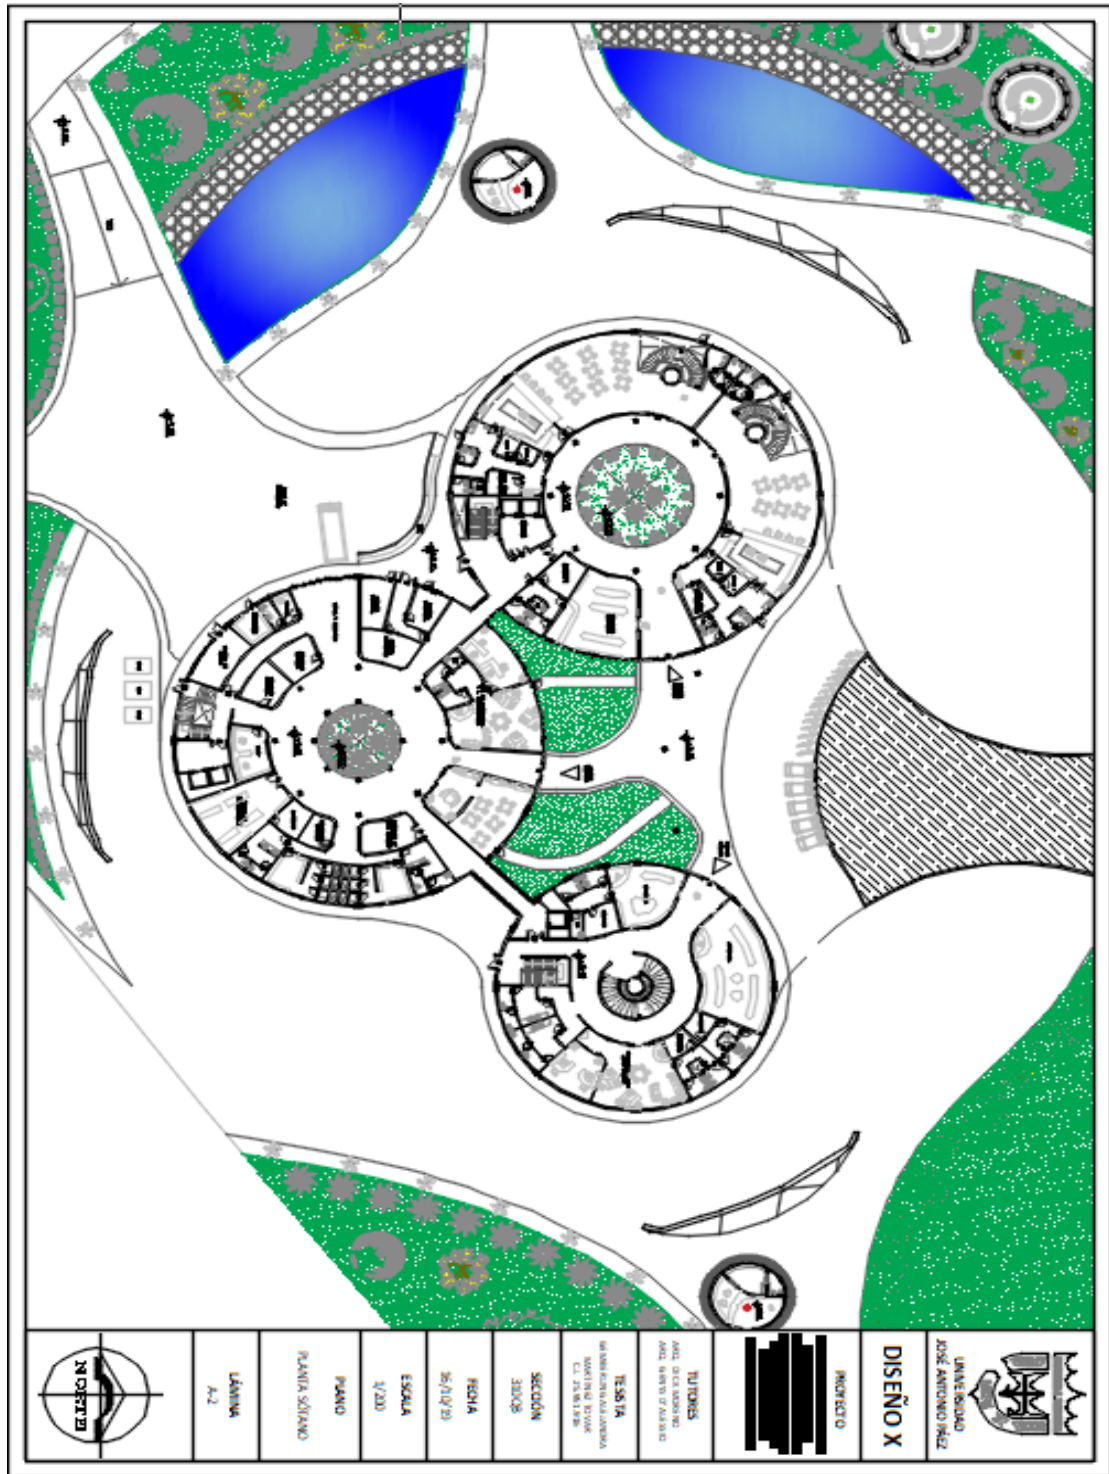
Planta Sótano. Autor: Gemberling Martínez (2018)
